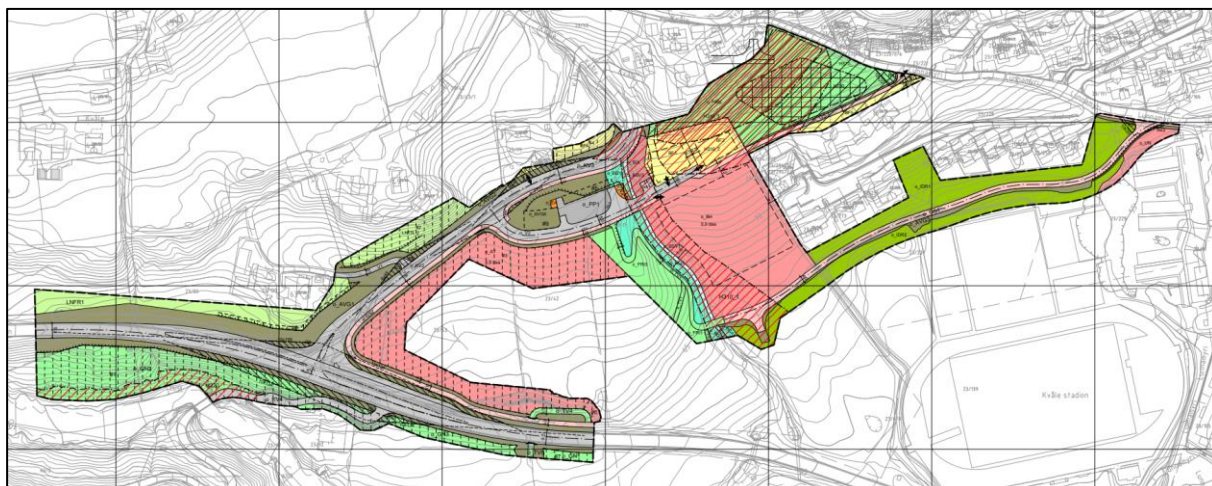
Lokalisering av planområdet. Svart heiltrukken strek syner planområdet (Asplan Viak AS)
